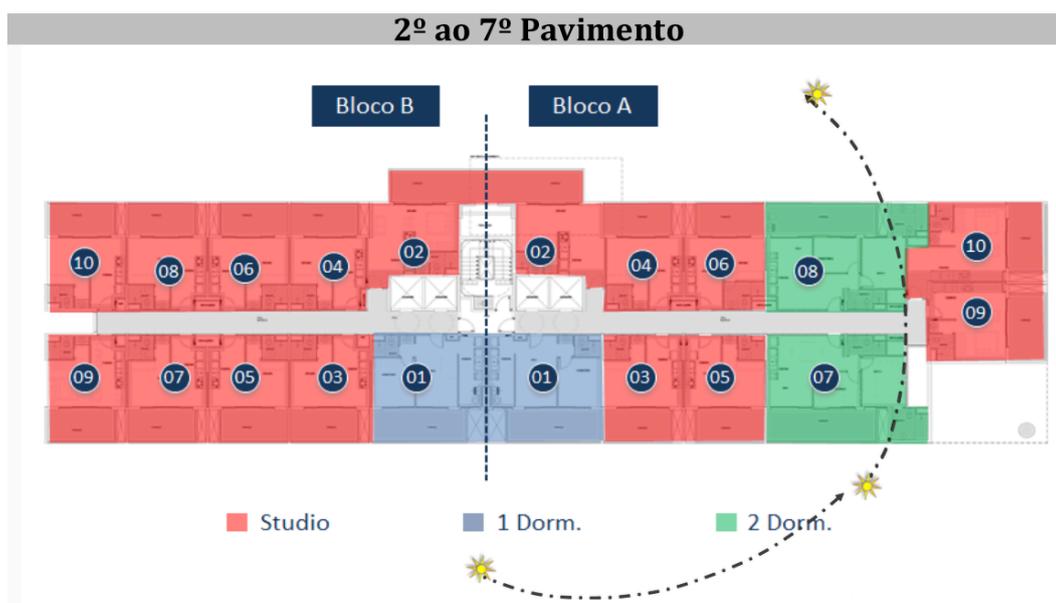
Implantação 2º ao 7º Pavimento London – SP Residence
